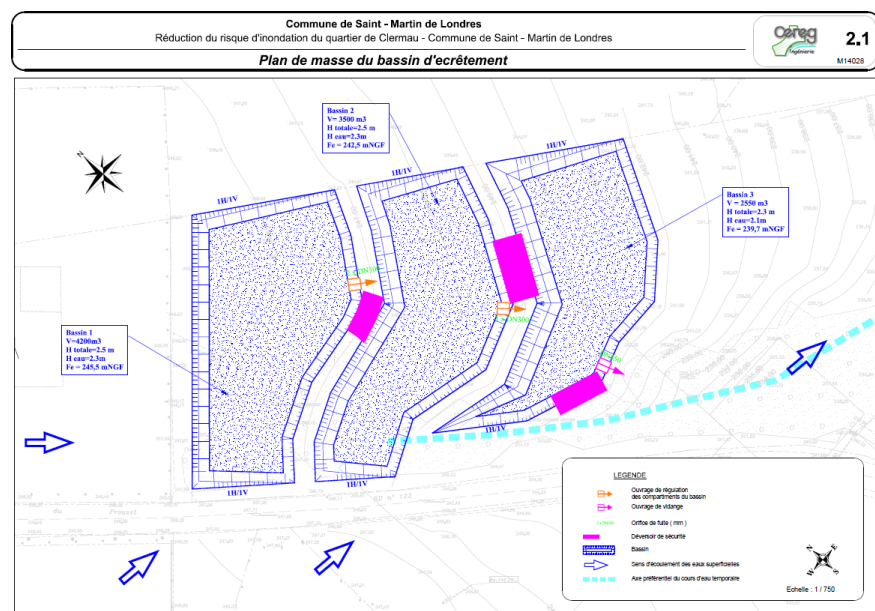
Plan de masse du bassin d'écrêtement (Source : Cereg)
